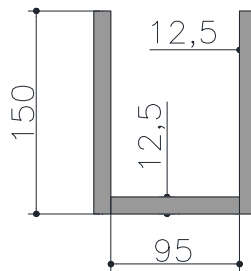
Características geométricas do perfil metálico utilizado como consolo metálico.
